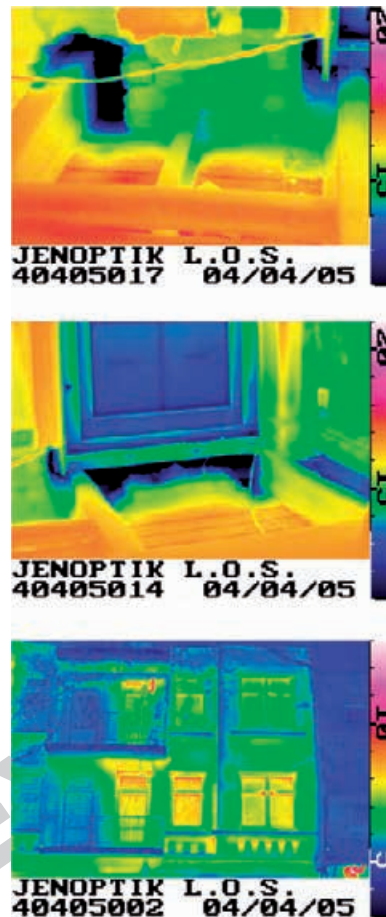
Thermografieaufnahmen: freigelegte Balkenköpfe Außenwand (oben), freigelegte Balkenköpfe Balkontür (Mitte) und Fassadenausschnitt (unten)
